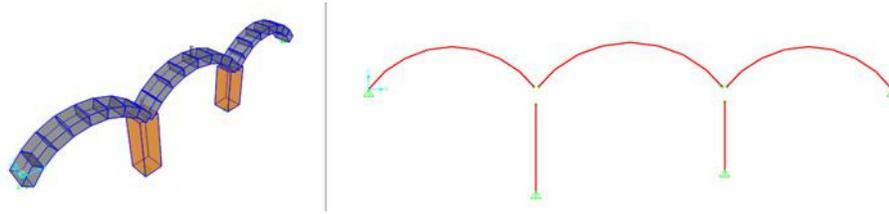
Estructura modelizada como pórtico plano (faja de 1m de ancho).
